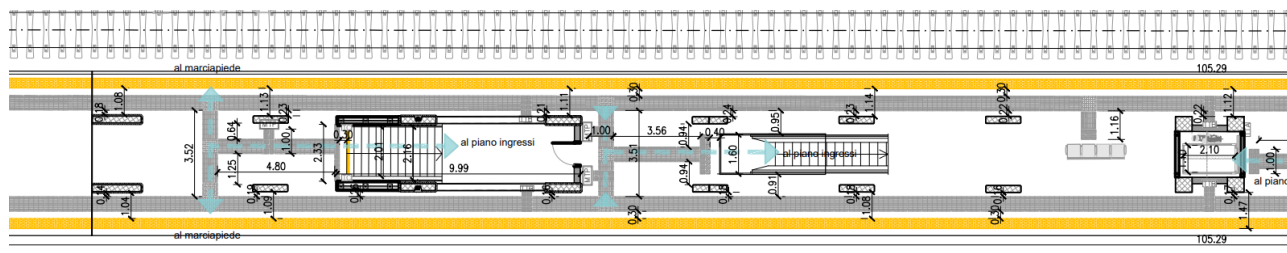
Stralcio Planimetria percorsi tattili nuove Banchine.
